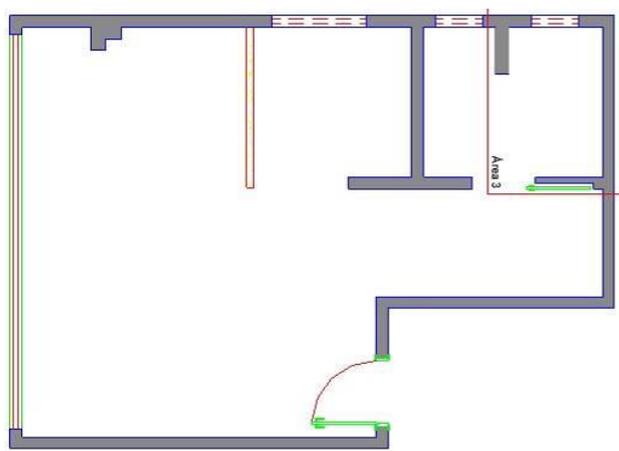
Elemento Estrutural e detalhe do local da inspeção detalhada na laje de piso do apartamento.
